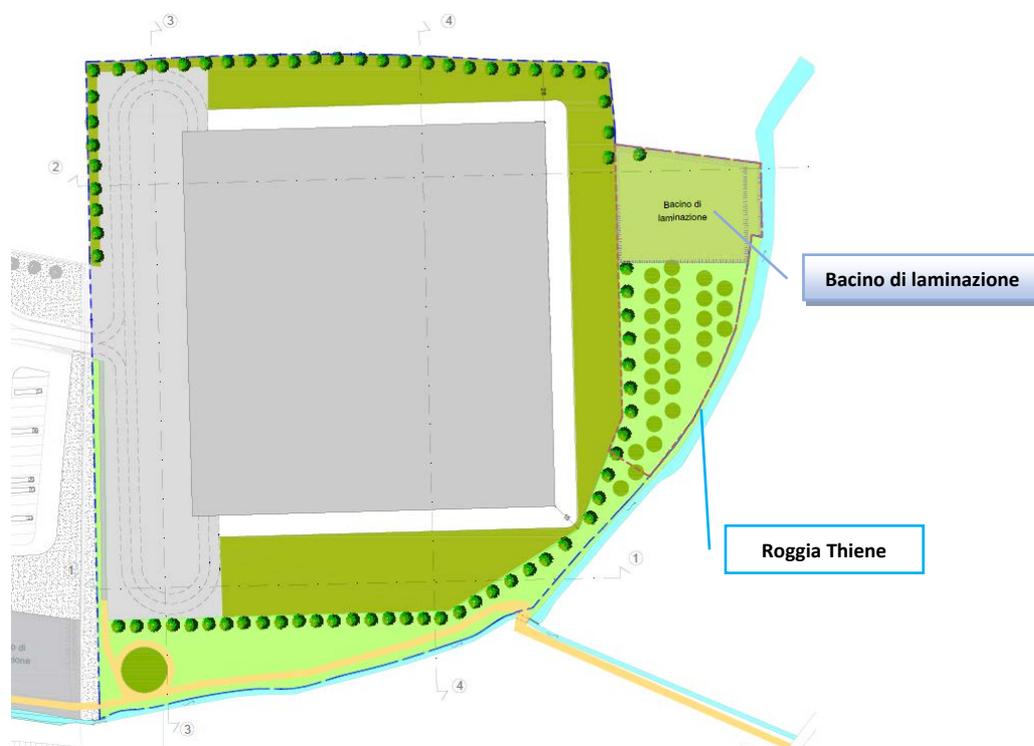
Planimetria stato di progetto con individuazione del bacino di laminazione e del corpo idrico ricettore
